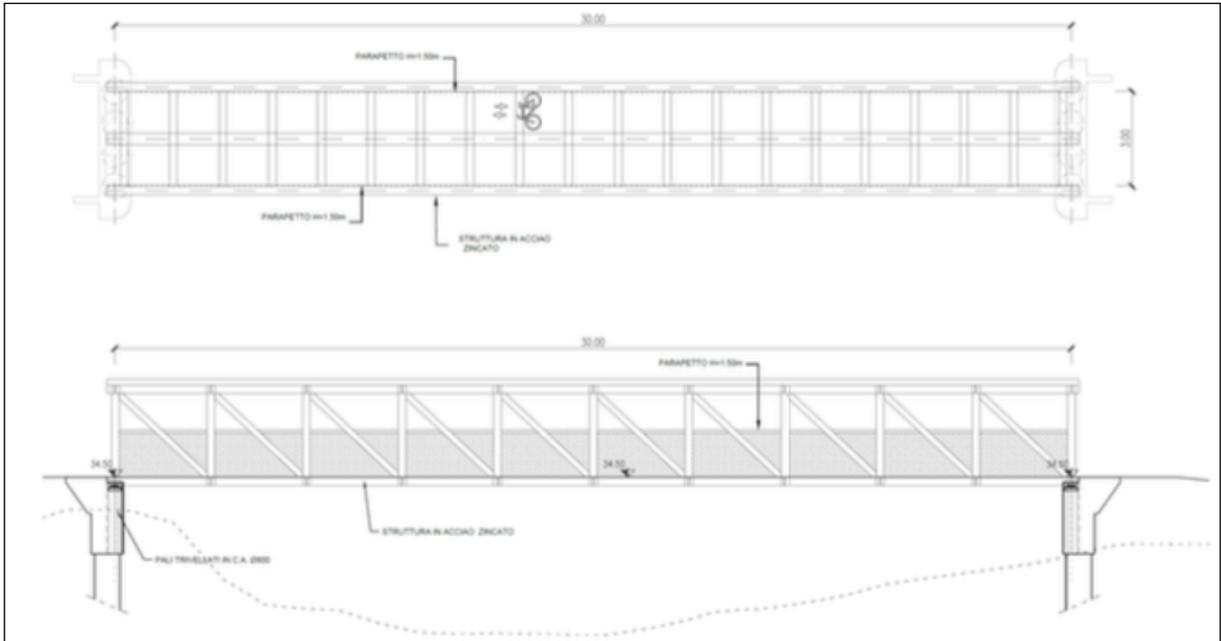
Pianta e prospetto ponte dl Torrente Isolone
